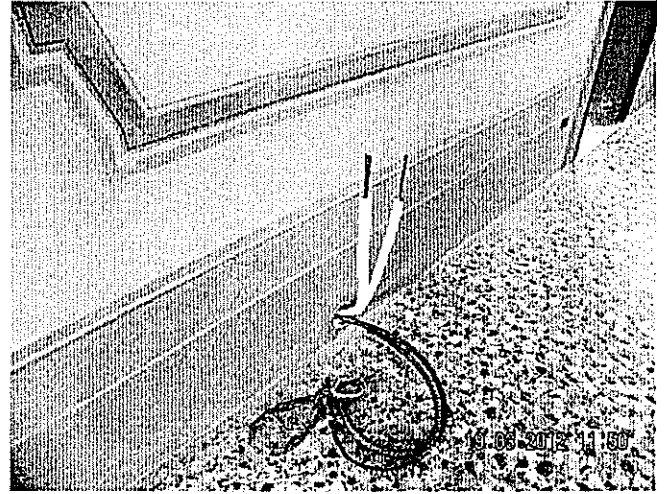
Stanza 1.5 (sala)- Particolare impianti posati
